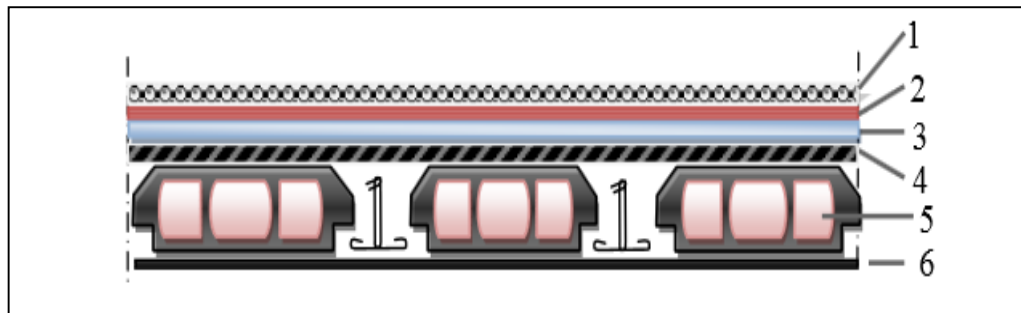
Détail des constituants du plancher terrasse inaccessible.
